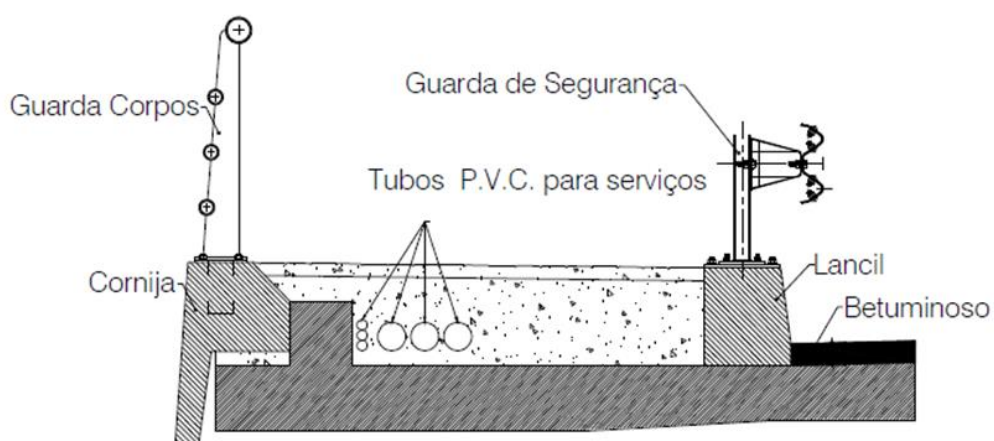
Pormenor de um passeio.(Costa, 2009)
